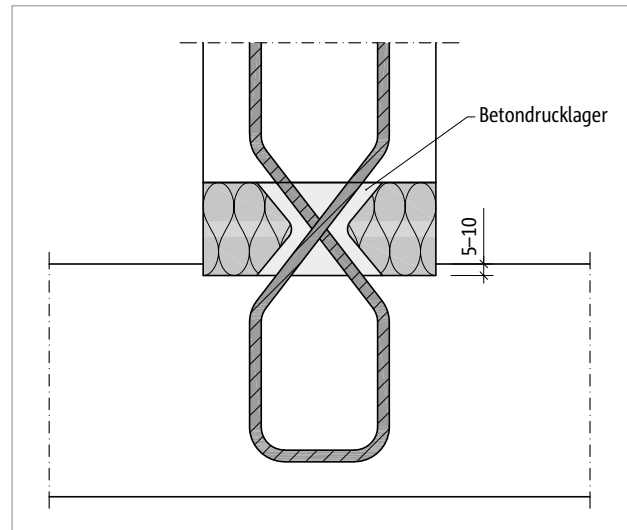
Schöck Sconnex® Typ W: Detail 1; Formschluss durch 5–10 mm tiefe Einsenkung des Dämmkörpers in die Decke
